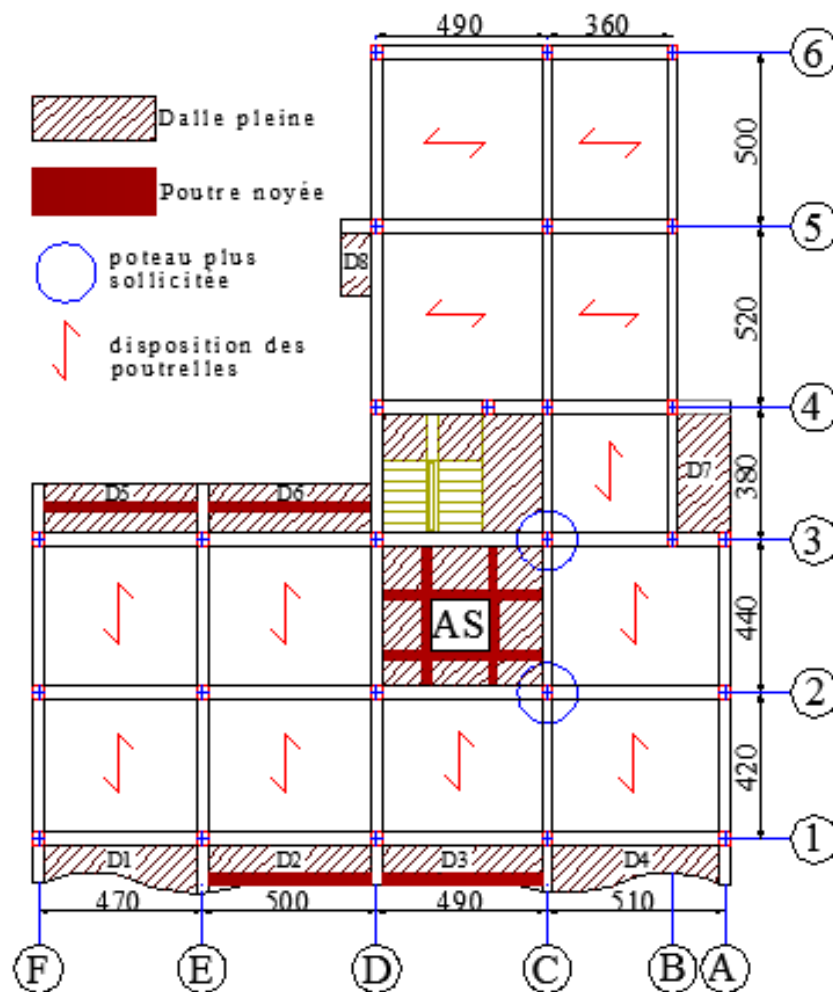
Disposition des différents panneaux en dalle pleine.
